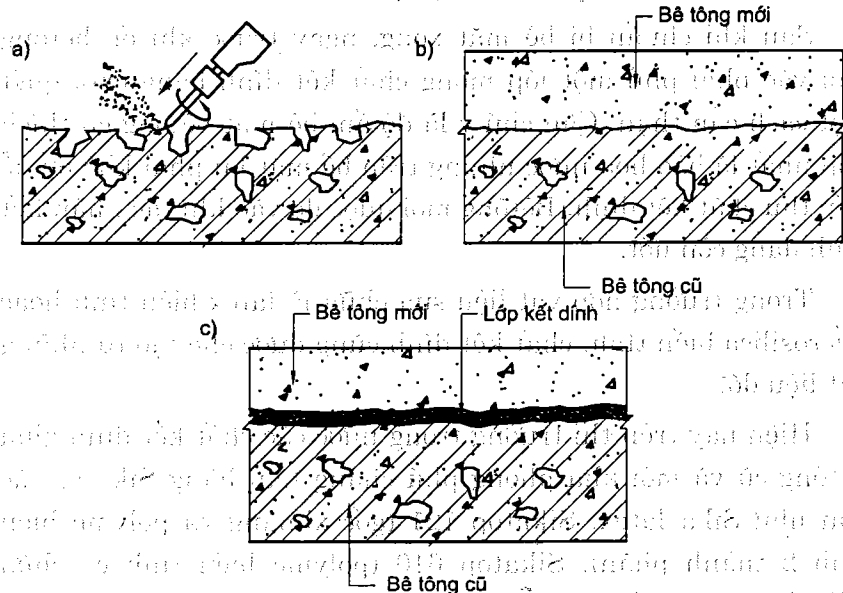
Sơ đồ cơ cấu tạo độ dính giữa hai lớp bê tông cũ và mới
